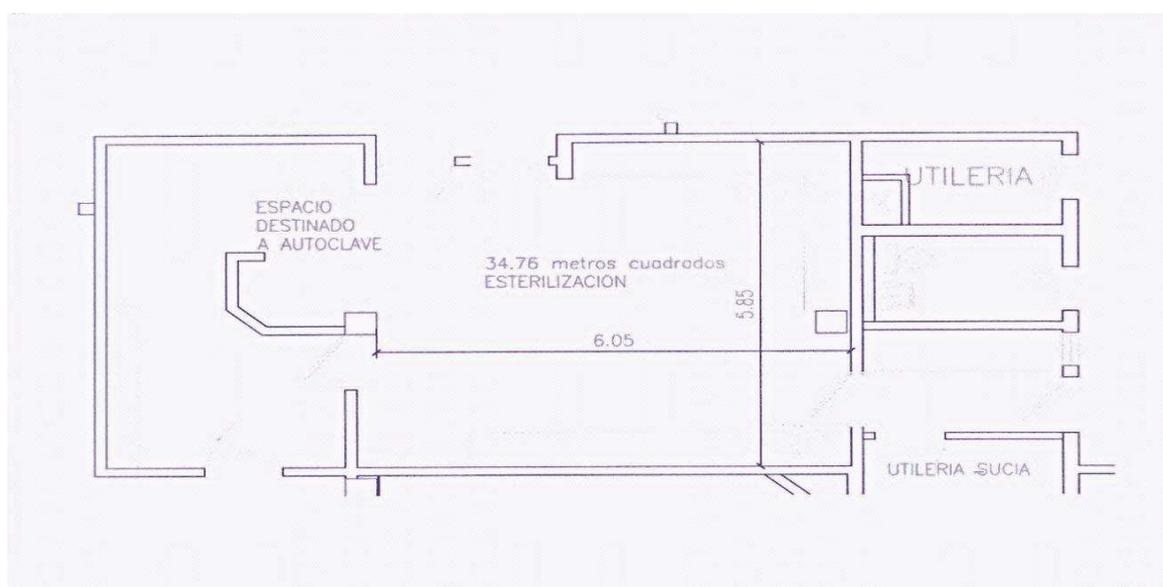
Plano de la sala de esterilización con las dimensiones
